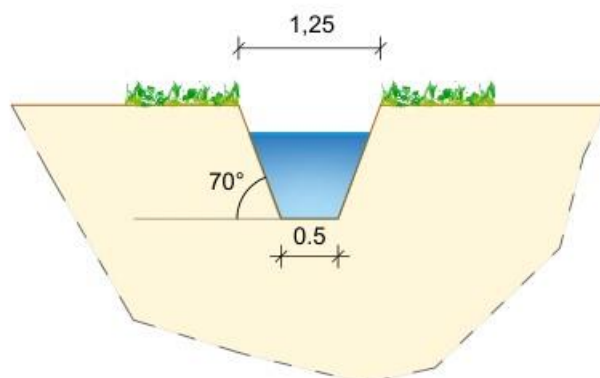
Sezione tipo dei nuovi canali di drenaggio
